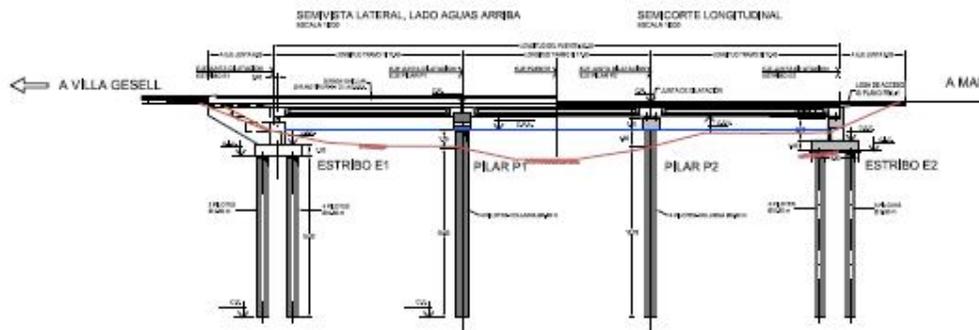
Detalle Sección Puente sobre A° Las Gallinas
